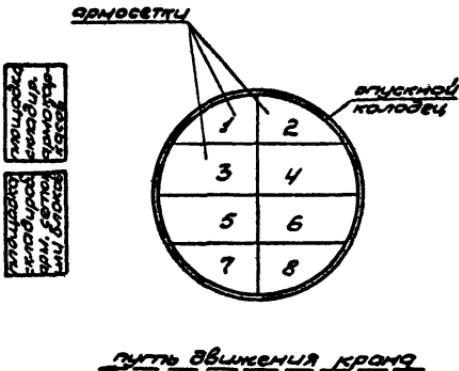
Схема последовательности укладки арматурных сеток (нижних и верхних) или блоков днища колодца I, 2, 3 и т.д. — порядковые номера укладки арматурных сеток или блоков
